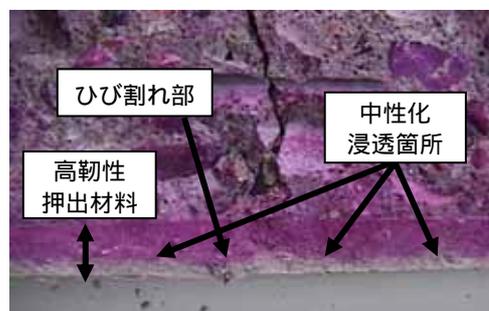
「ひび割れ部」DFRCC 複合体
